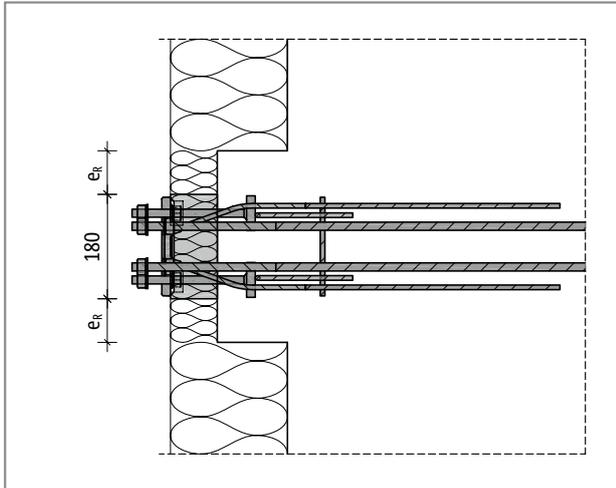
Schöck Isokorb® T Typ SK: Randabstände
